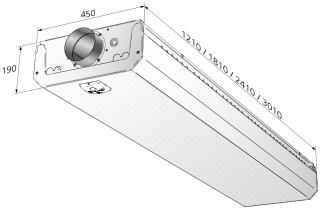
Dimensions – ADRIATIC AWC Prisma Lorsque le module de détection est installé dans la façade avant, la hauteur augmente de 12 mm.
